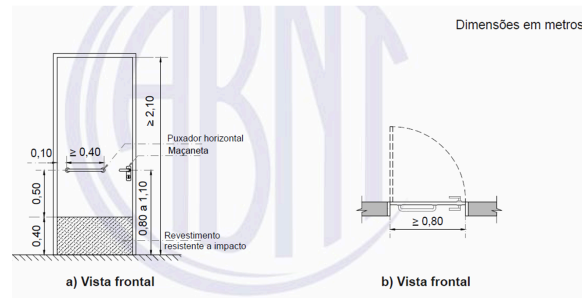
Barra de apoio e revestimento resistente a impacto na porta do sanitário (NBR 9050/2020).
